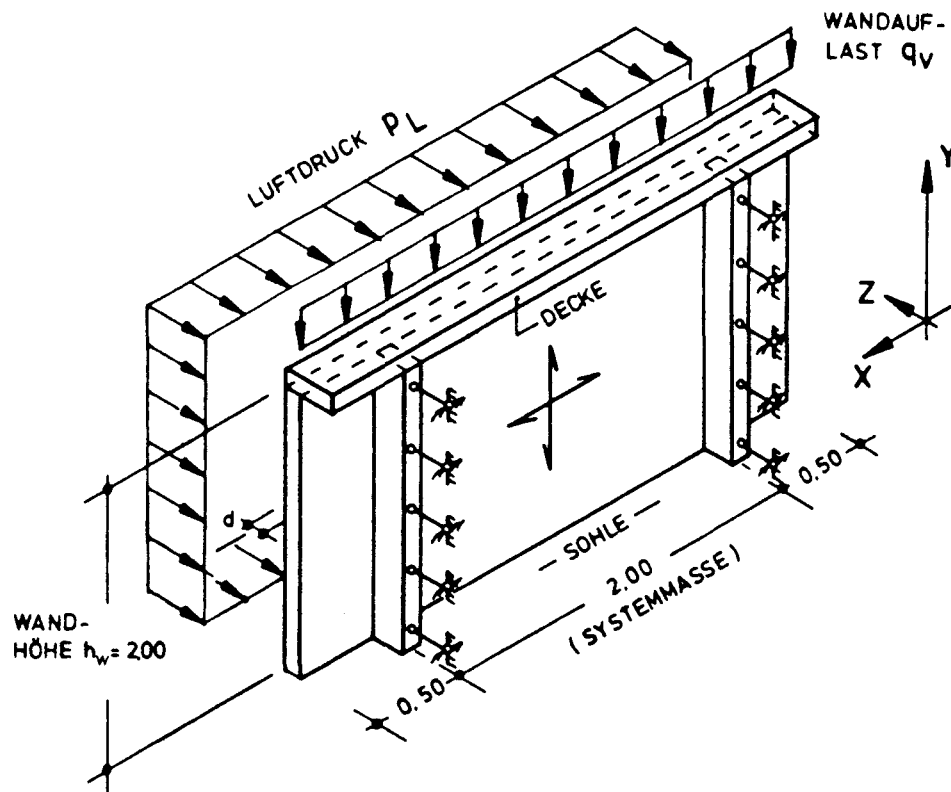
Statisches System kreuzweise biegebeanspruchter Mauerwerkswände
